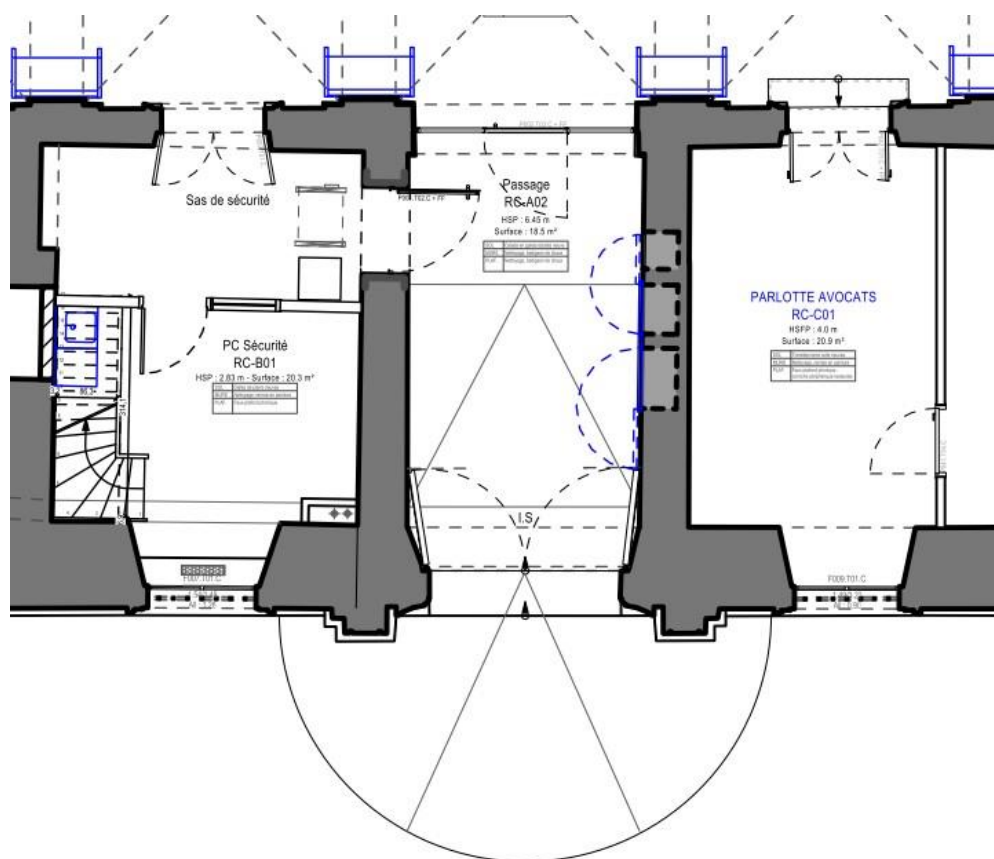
Représentation sur plan de la forme de rampe rayonnante
